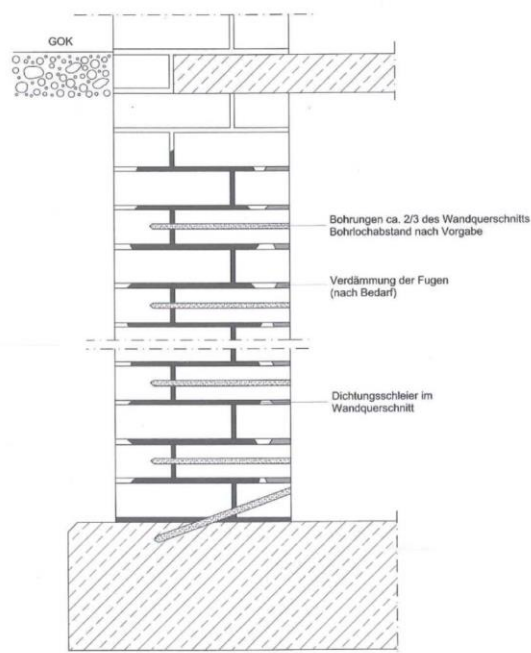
Injektionsverfahren - Flächenabdichtung im Bauteil, Planung und Ausführung nach WTA Merkblatt 5-20
